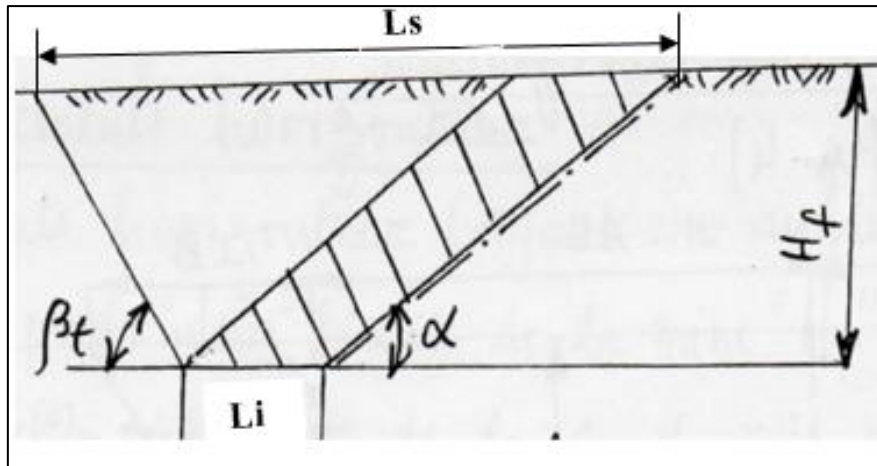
Dimensions de la carrière pour les gisements inclinés.
